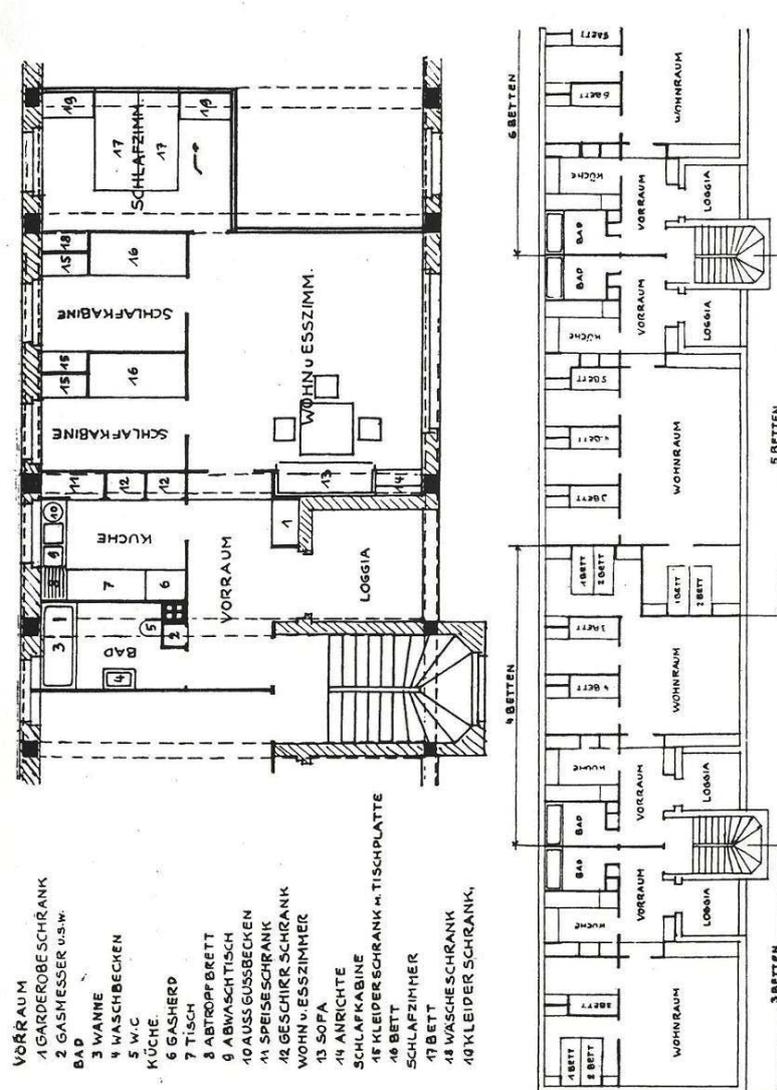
Ludwig Hilberseimer, Grundrisse von Wohnungen mit Einzelschlafzimmern, Kabinensystem 1923; oben: Grundriss einer Wohnung von vier Betten; unten: Grundrissvariationen von 3, 4, 5 und 6 Betten
